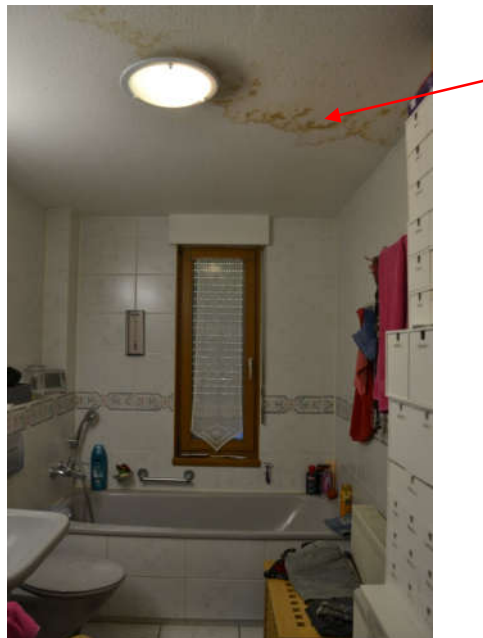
Erdgeschoss Bad, Feuchtigkeitsschaden (Pfeil)
